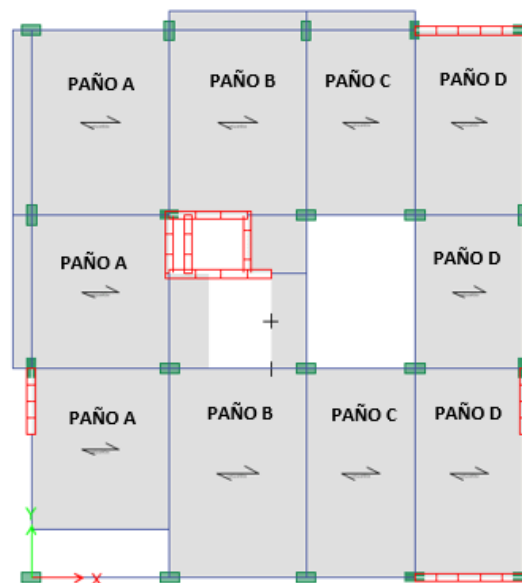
Ubicación de paños para el predimensionamiento de las losas aligeradas
